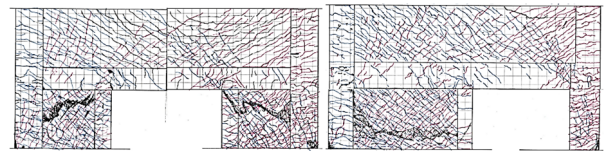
正載荷の終局破壊性状のひび割れ図
